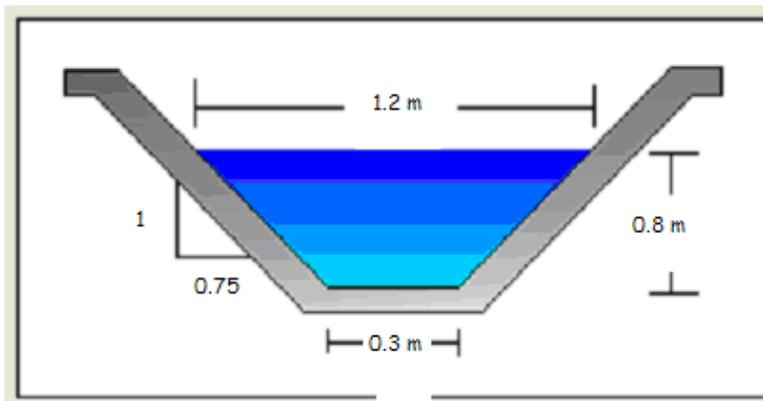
Dimensiones canal construido con el Balde Trapezoidal
